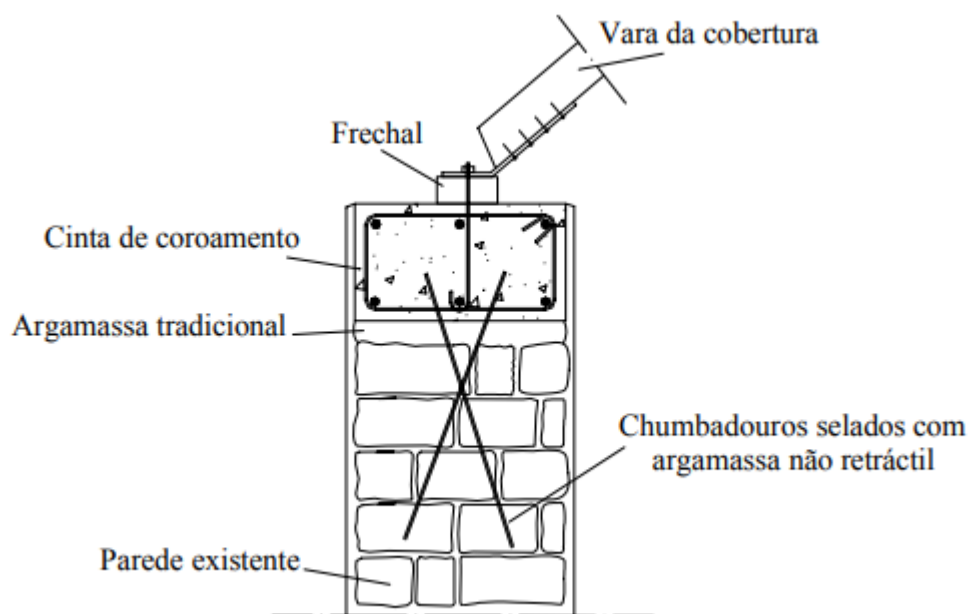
Viga cinto no topo da parede de alvenaria com ligação metálica à cobertura [20]
